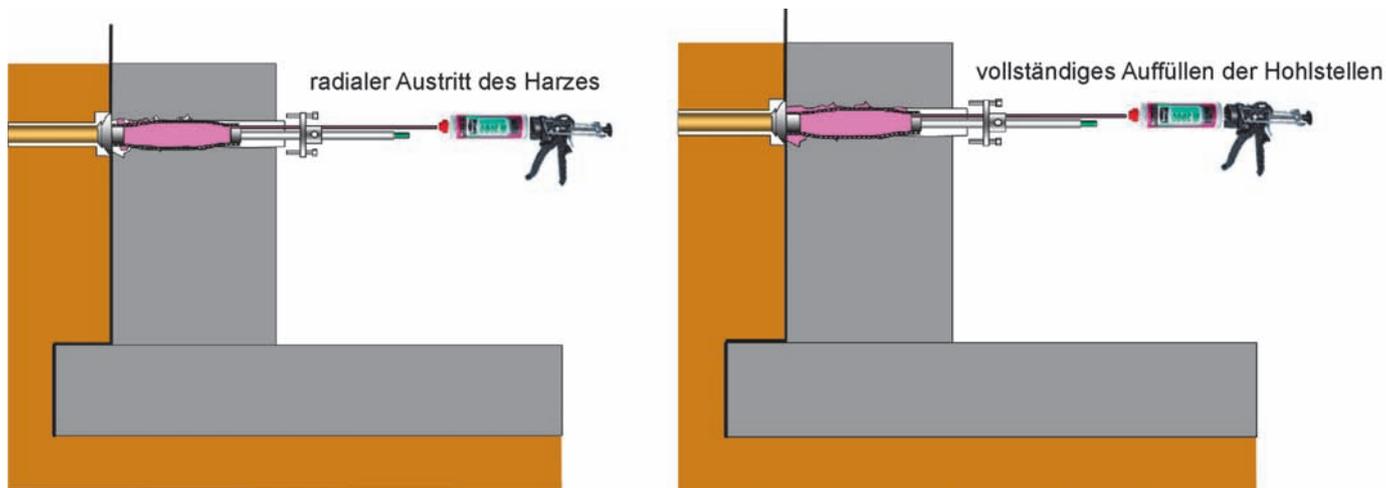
Glasfaseranschluss mit dem neuen System MIS 60: radialer Harzaustritt (links) mit anschließendem vollständigem Ausfüllen der Hohlstellen
